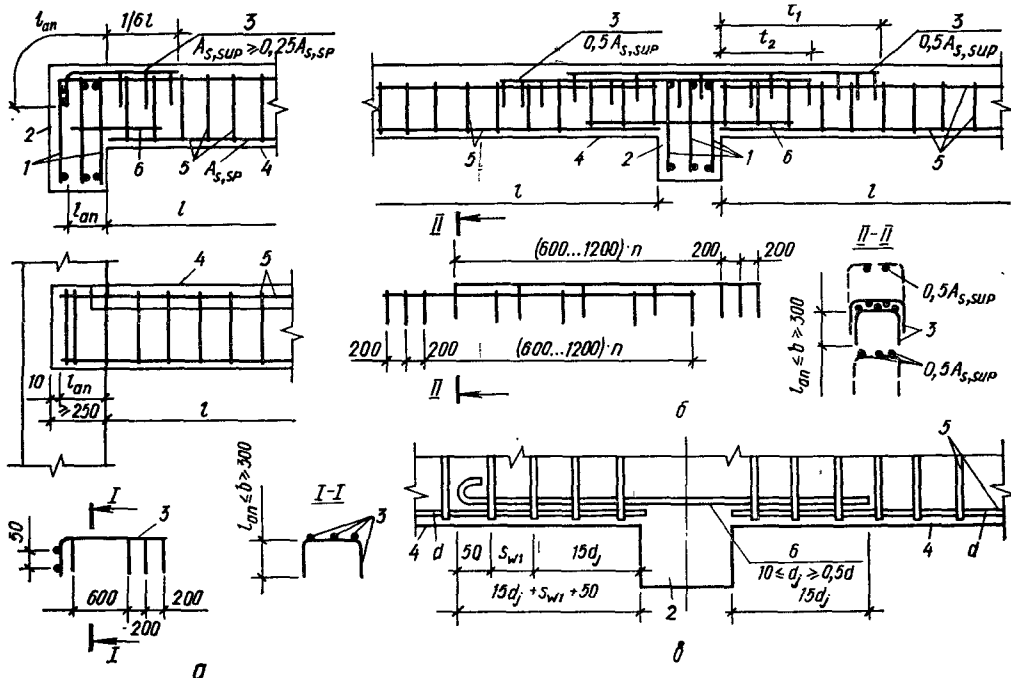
Армирование второстепенных монолитных балок сварными сетками:
